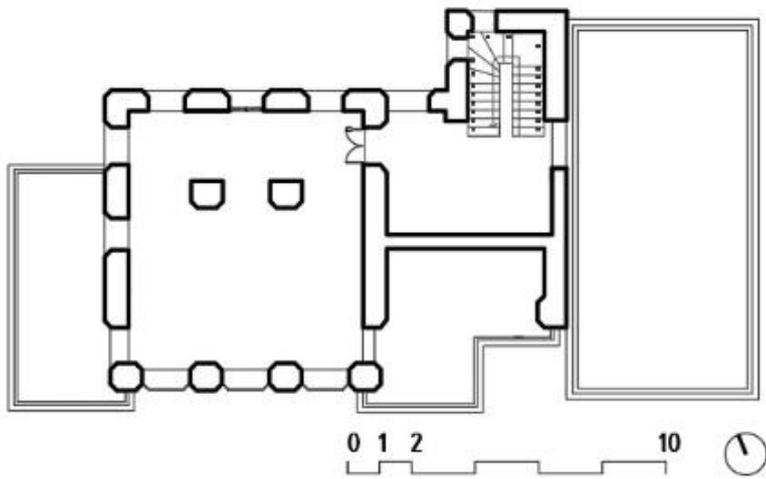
Sanatorio de Cesuras, planta segunda. Elaboración propia
